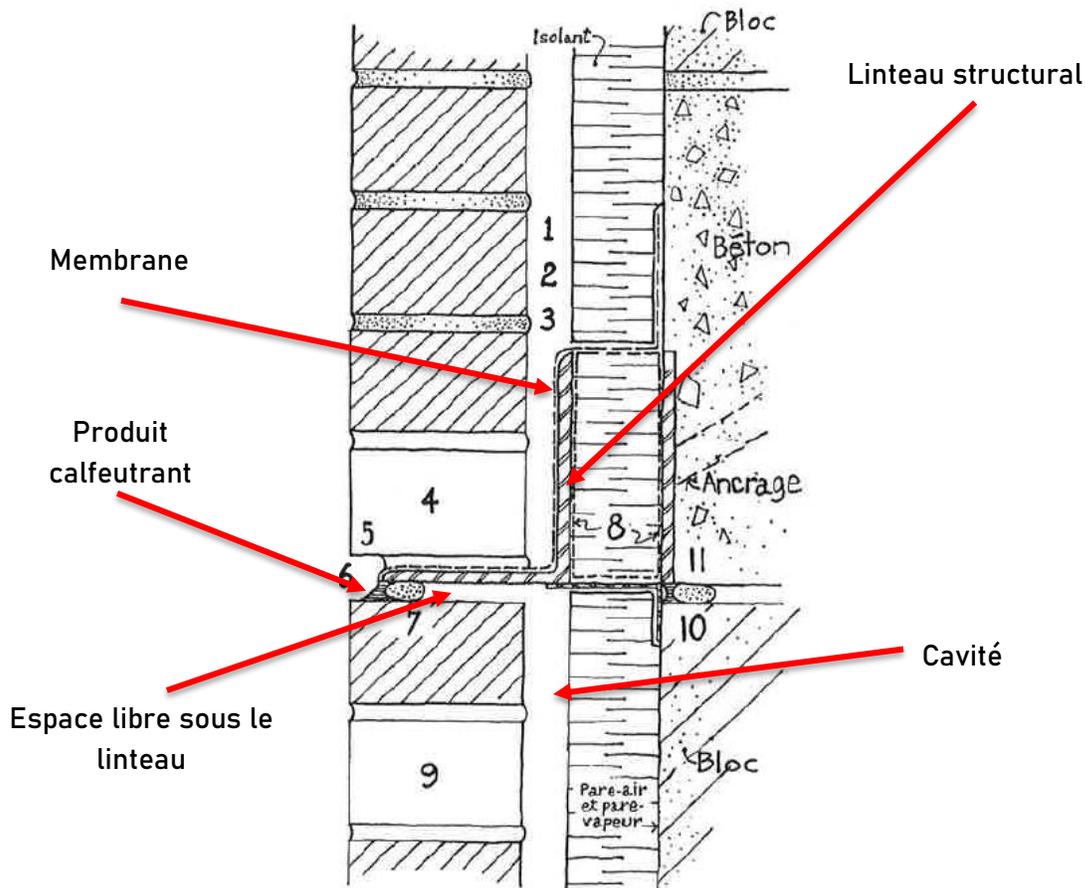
Coupe typique d'un mur de maçonnerie avec linteau structural et isolation
